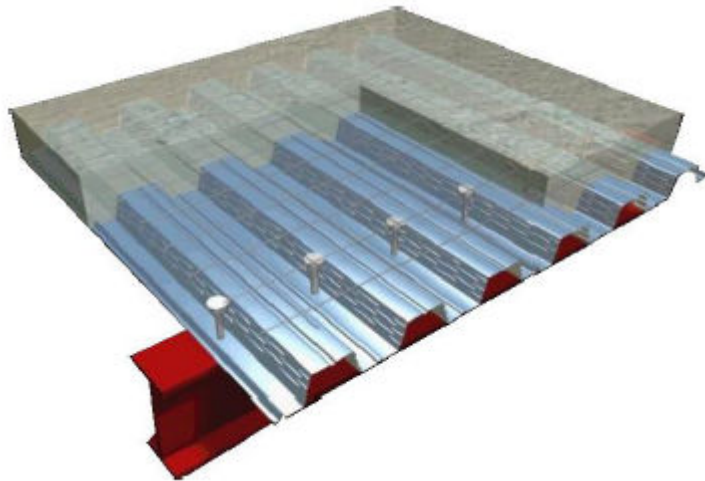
Laje Mista de aço e concreto, (Manual Técnico METFORM, 2016).
